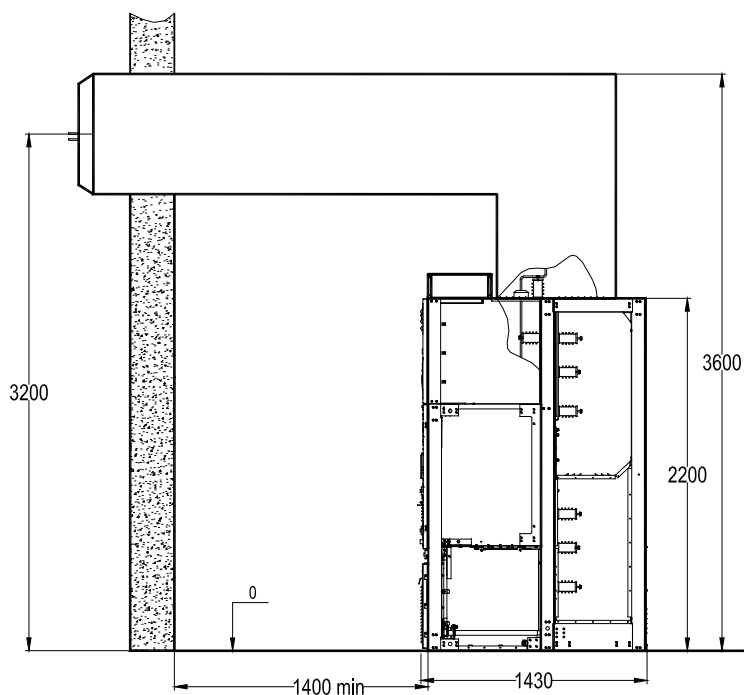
Размещение шкафов фасадом к стене здания
